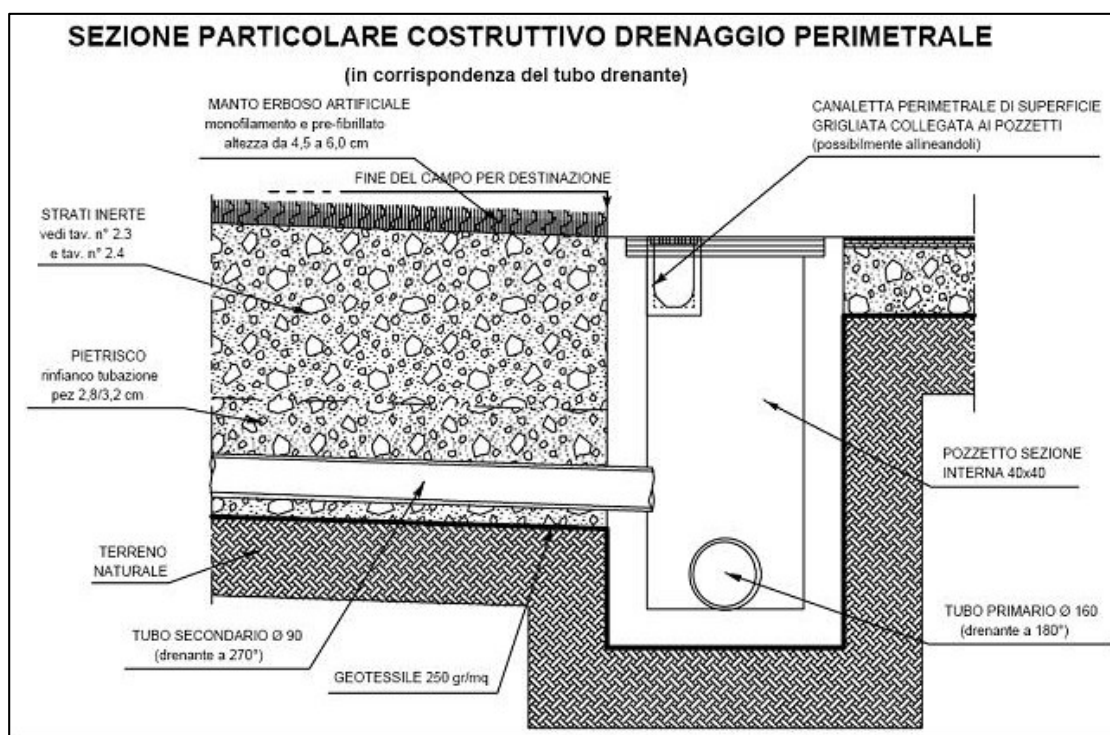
Sezione tipo particolare costruttivo drenaggio perimetrale
